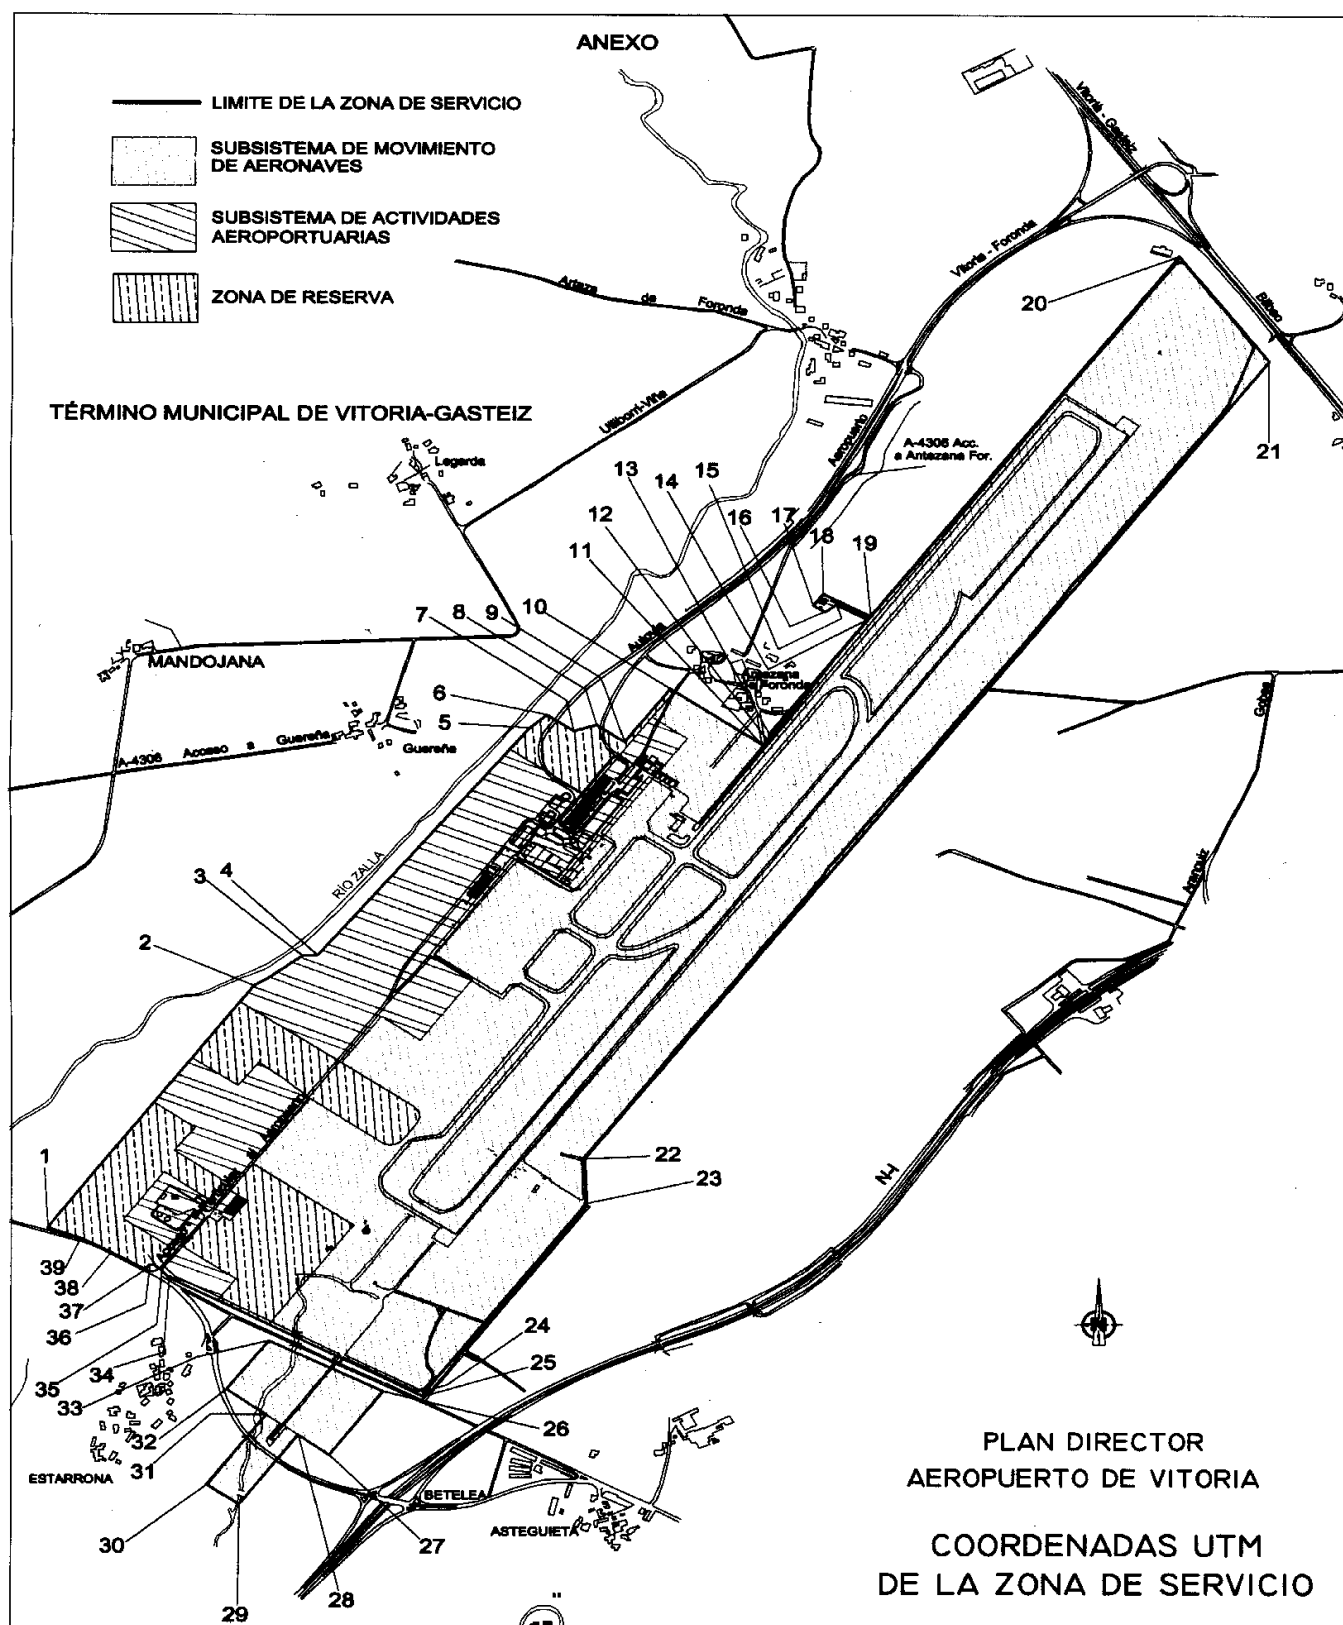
Planta del Aeropuerto Internacional de Vitoria. Fuente: MF (2001b).
